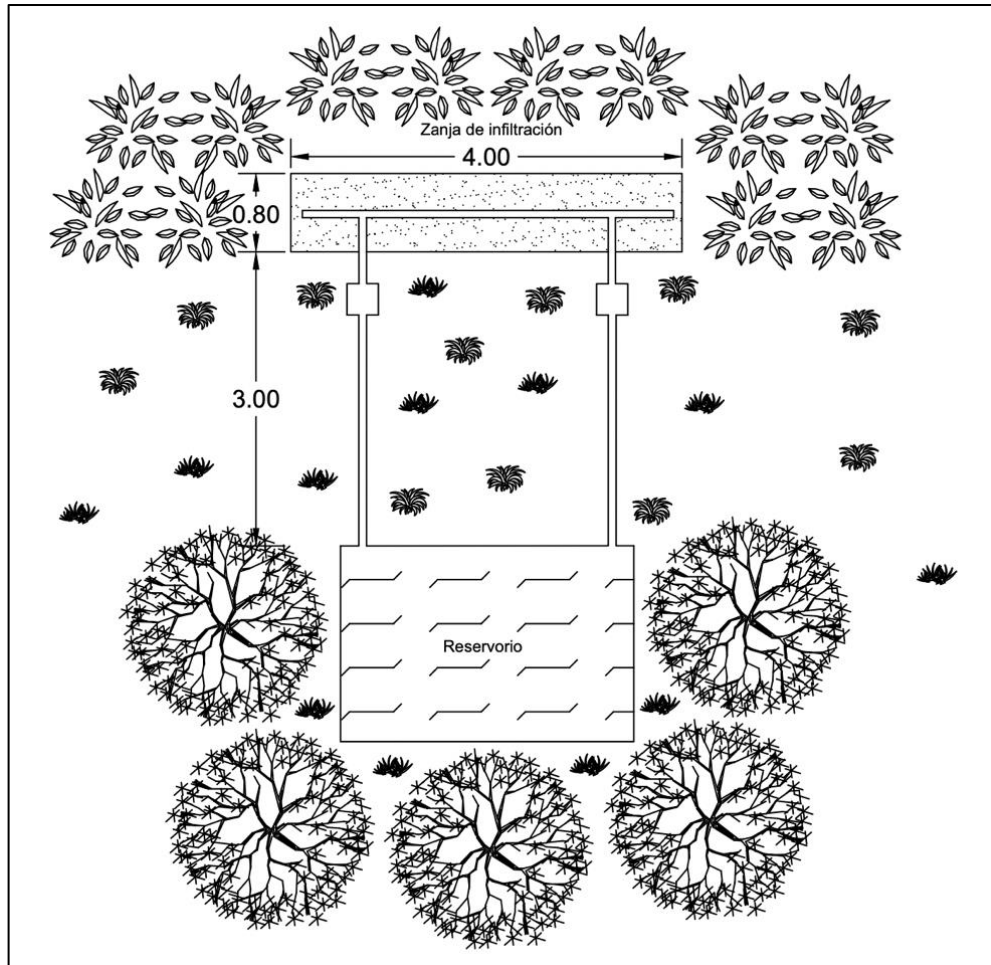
Zanja de infiltración vista en planta. Fuente. Gamboa, 2023
